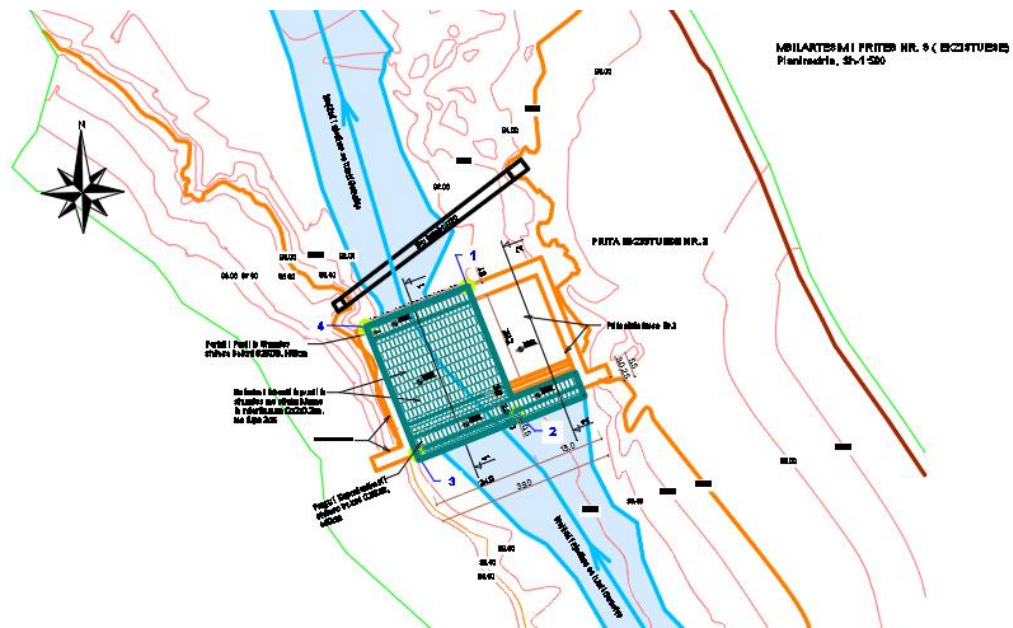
Planimetria e mbilartesimit ne priten ekzistuese Nr.3.
